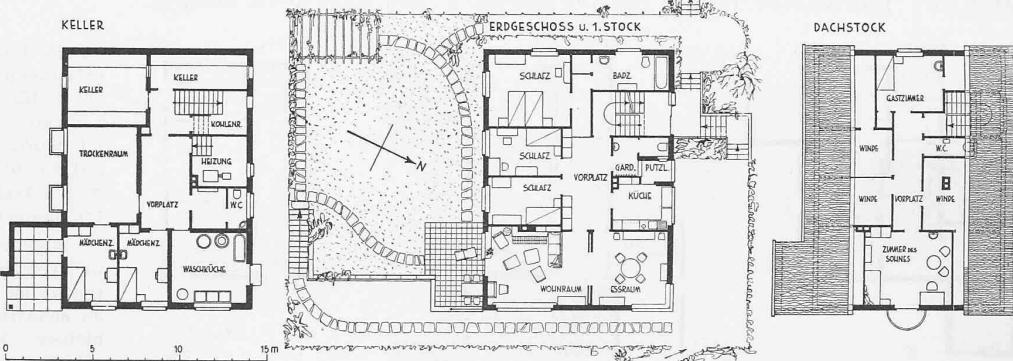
Grundrisse zu Abb. 14 und 15, Maßstab 1:400.
